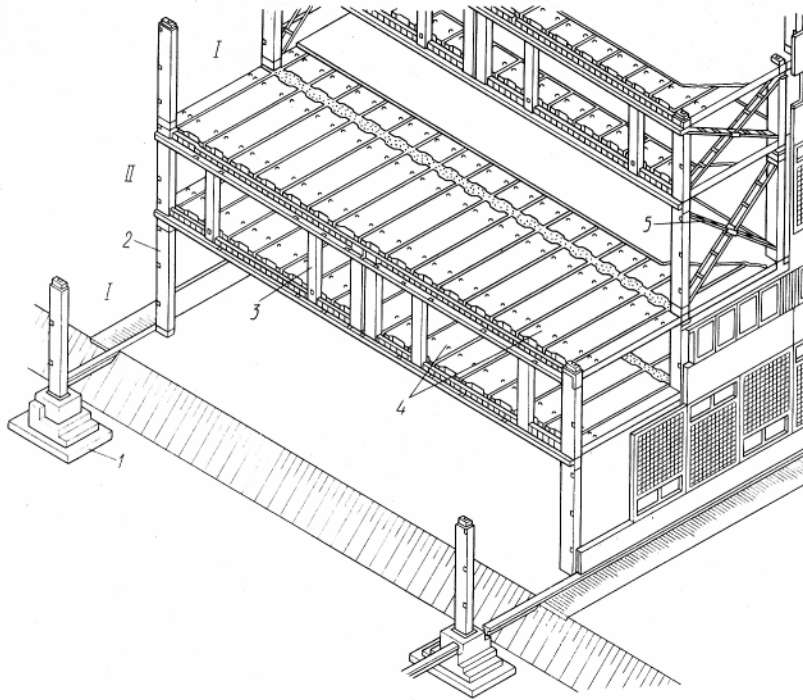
Каркас з перекриттями над виробничими поверхами, що працюють «на проліт»:
